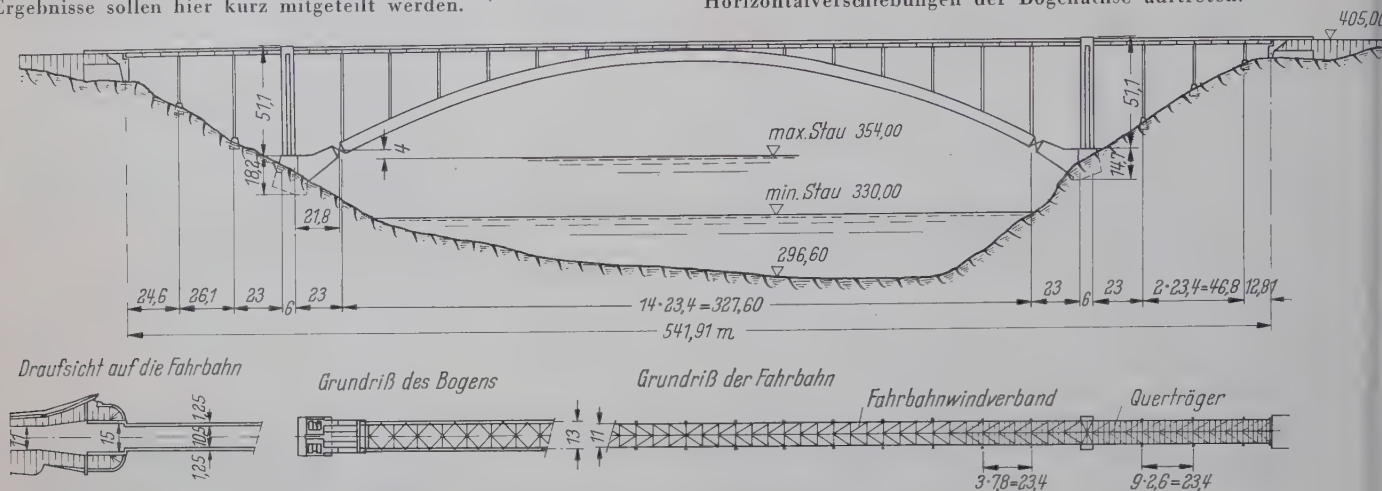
Ansicht und Grundriß einer Straßenbrücke über einen Stausee
